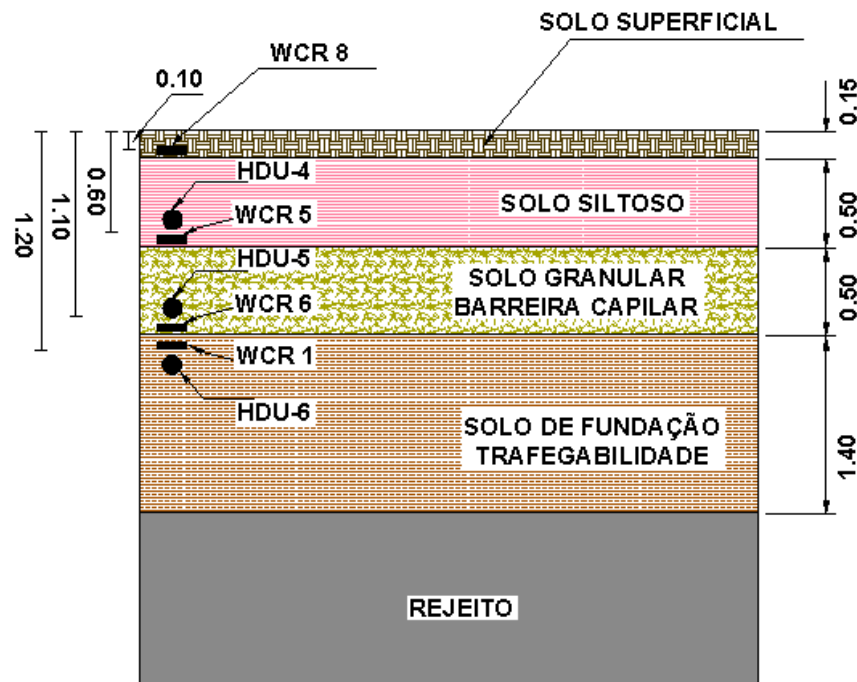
Perfil esquemático do sistema de cobertura 2 com a posição dos instrumentos.
